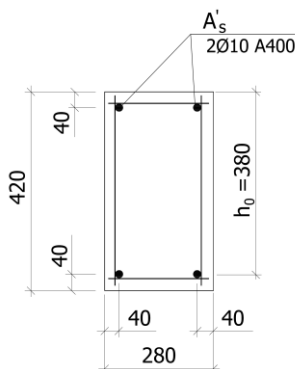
Подбор продольной сжатой арматуры верхнего пояса
